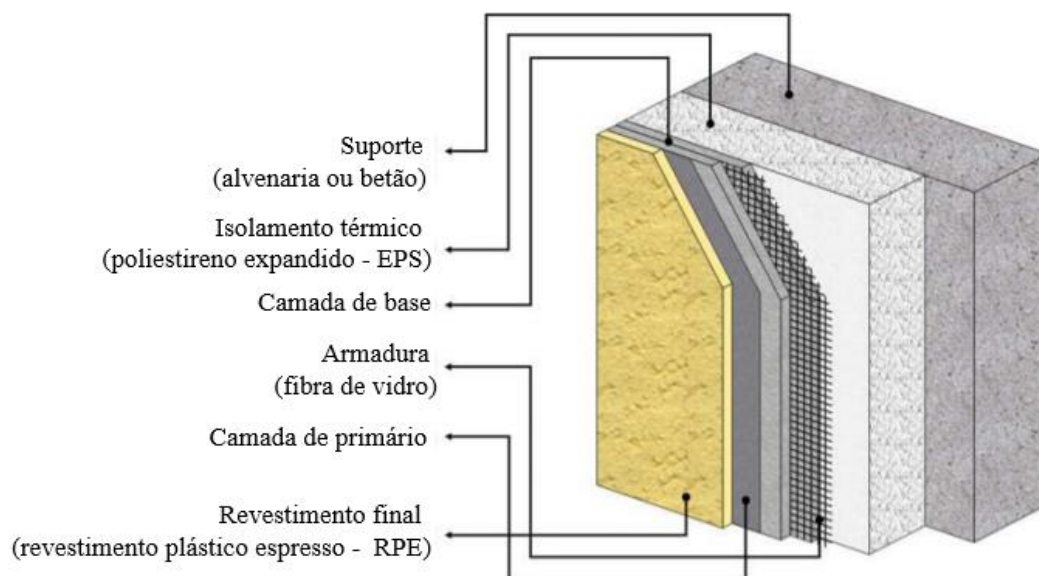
Pormenor construtivo de um sistema ETICS (APFAC, 2014)
